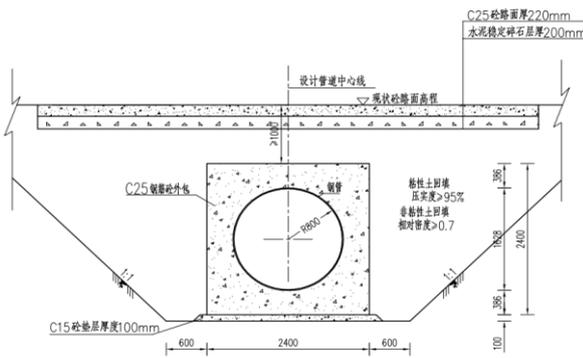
穿路埋管段设计典型二横断面图 (单位: mm)
